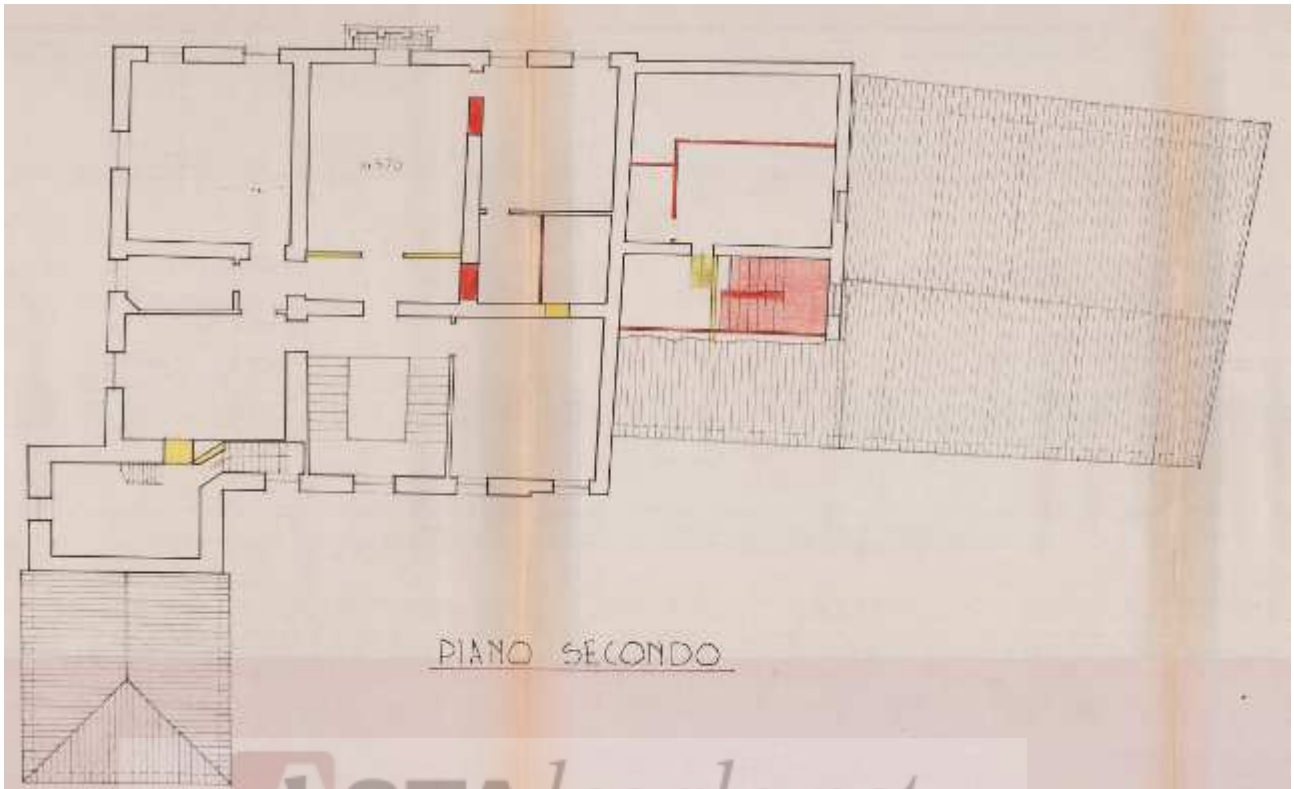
Stato approvato – p.lla 415 – piano secondo.
